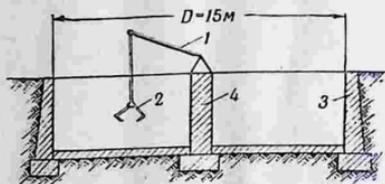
Механизированное навозохранилище: 1—вантовый кран; 2—грейфер; 3—бут; 4—бутобетон.
